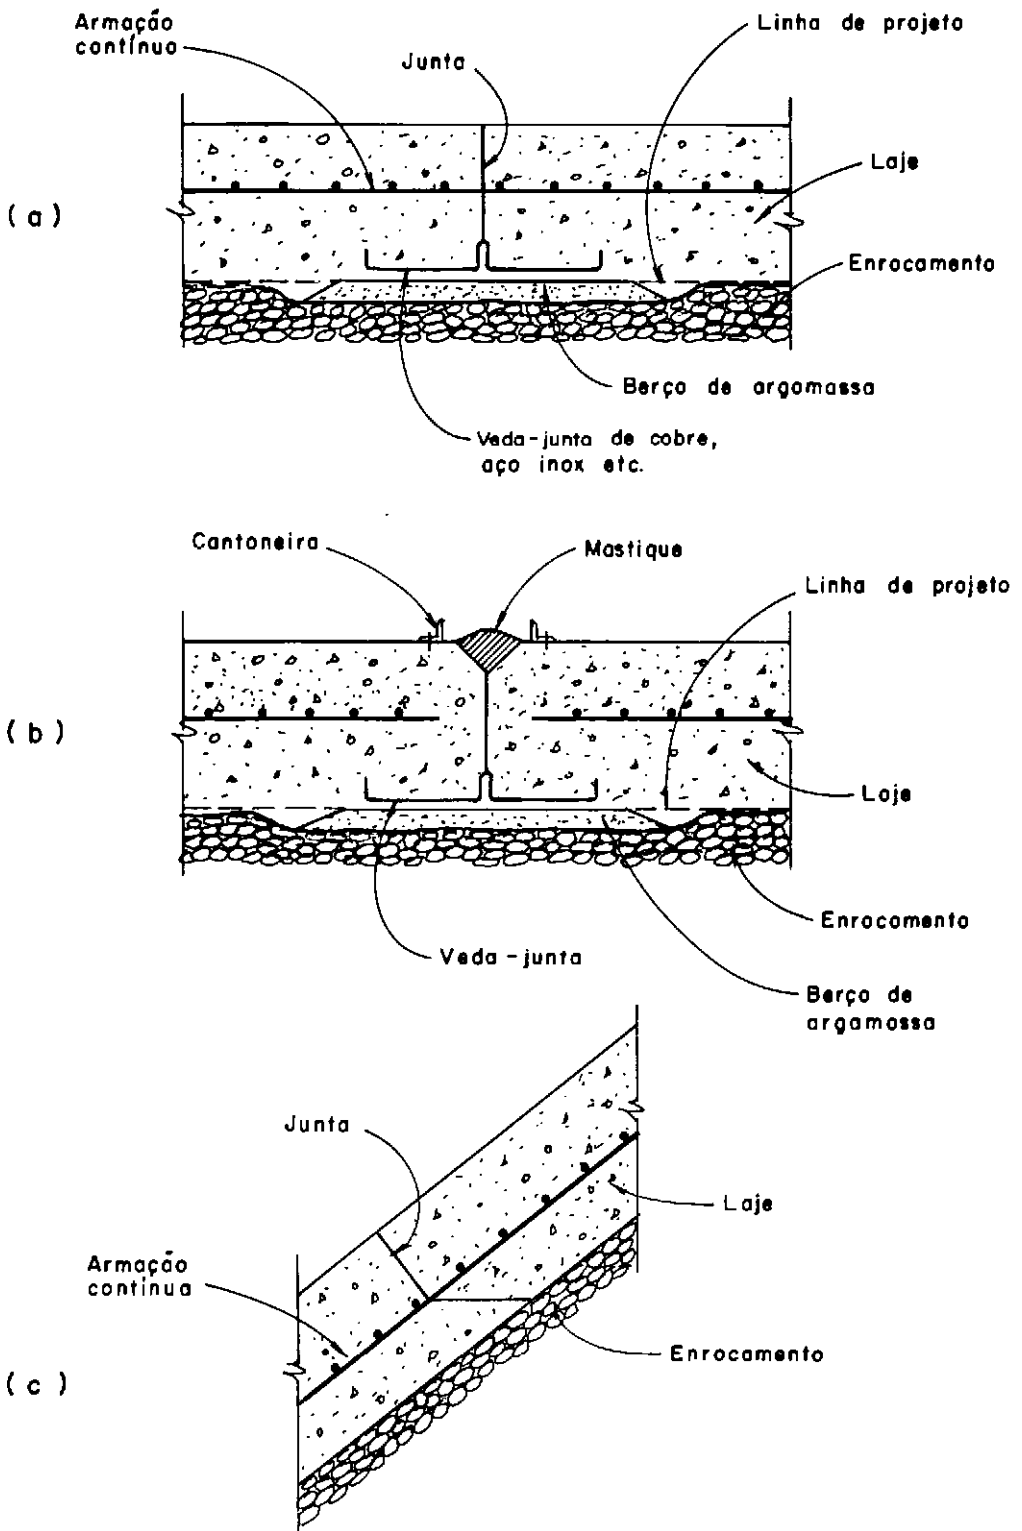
Detalhes das juntas da laje de concreto.
